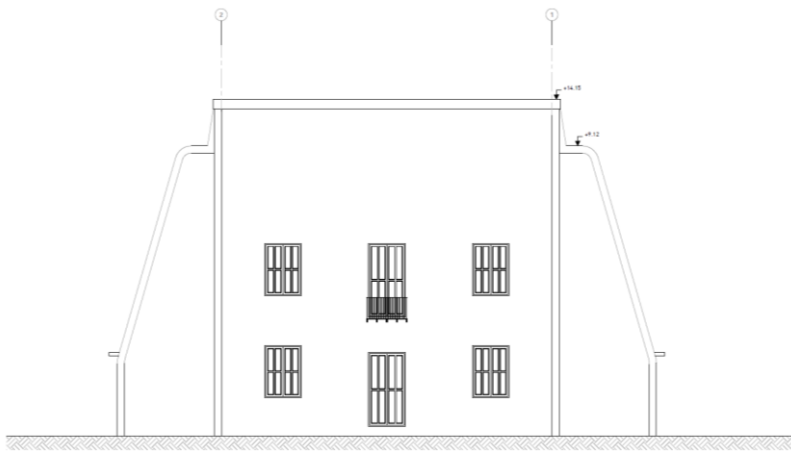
Alzado Este del Auditorio. Levantamiento realizado en el año 2019. Fuente: Autora. Ver Planos en los Anexos.
